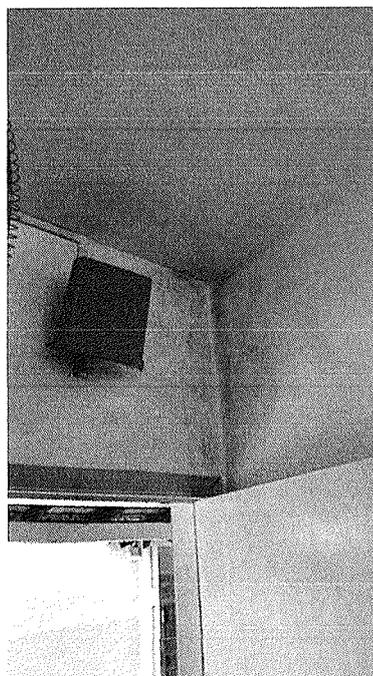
Infiltração decorrentes de defeitos no telhado. Sala de aula do pré 1, área interna
